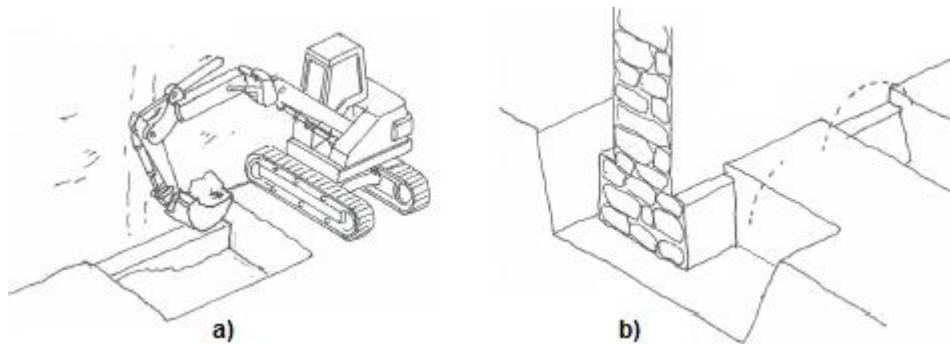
Escavação do terreno por troços alternados: a) equipamento de escavação; b) fundação visível e acessível aos trabalhos [55]
